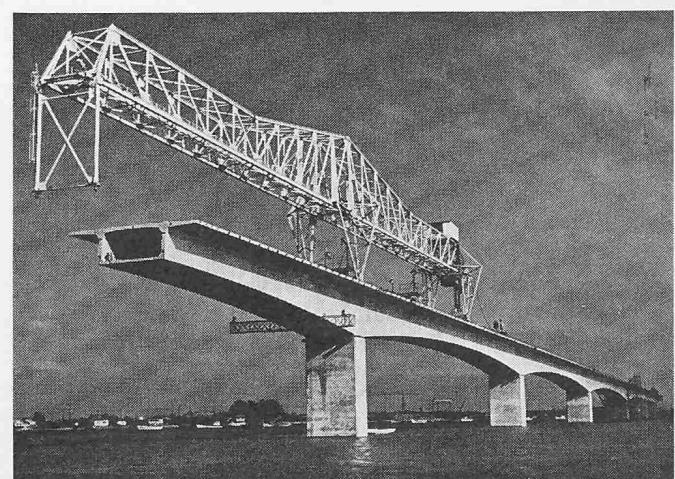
Stählerne Vorbauvorrichtung zum Zusammenbau des Überbaues der 3 km langen Brücke kurz vor dem Vorschieben zum nächsten Bauabschnitt auf dem zusammengebauten Überbauende
